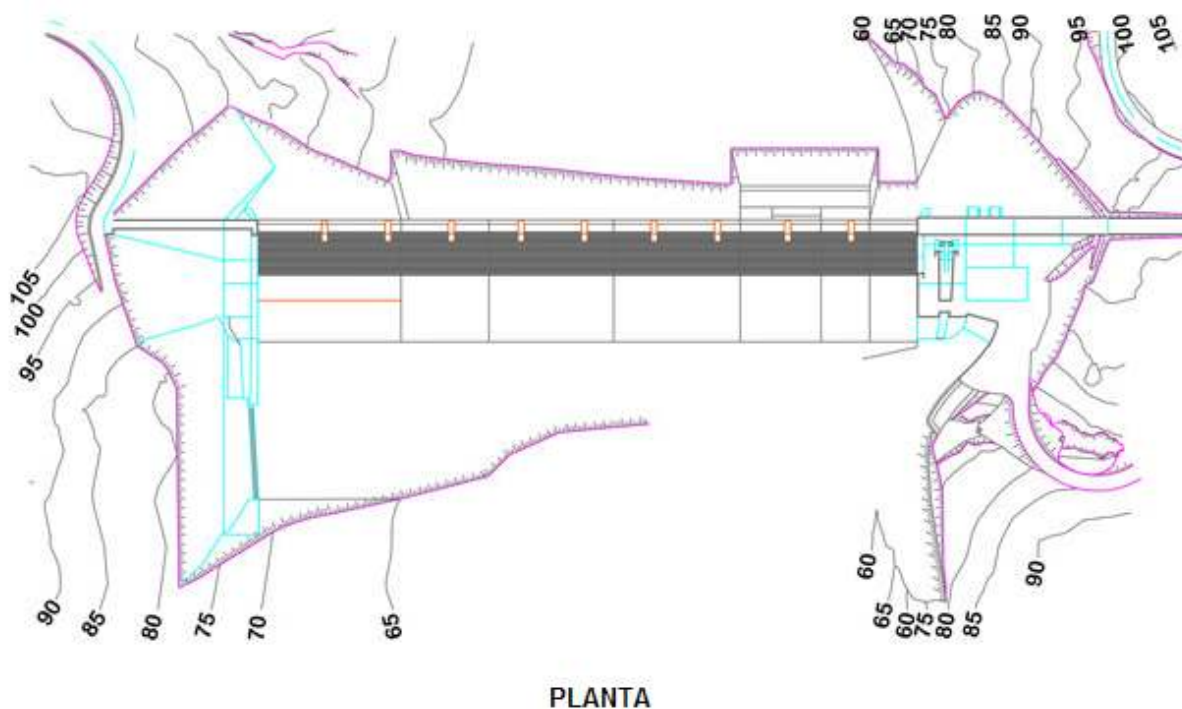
Barragem de Pedrógão – Planta [4]
